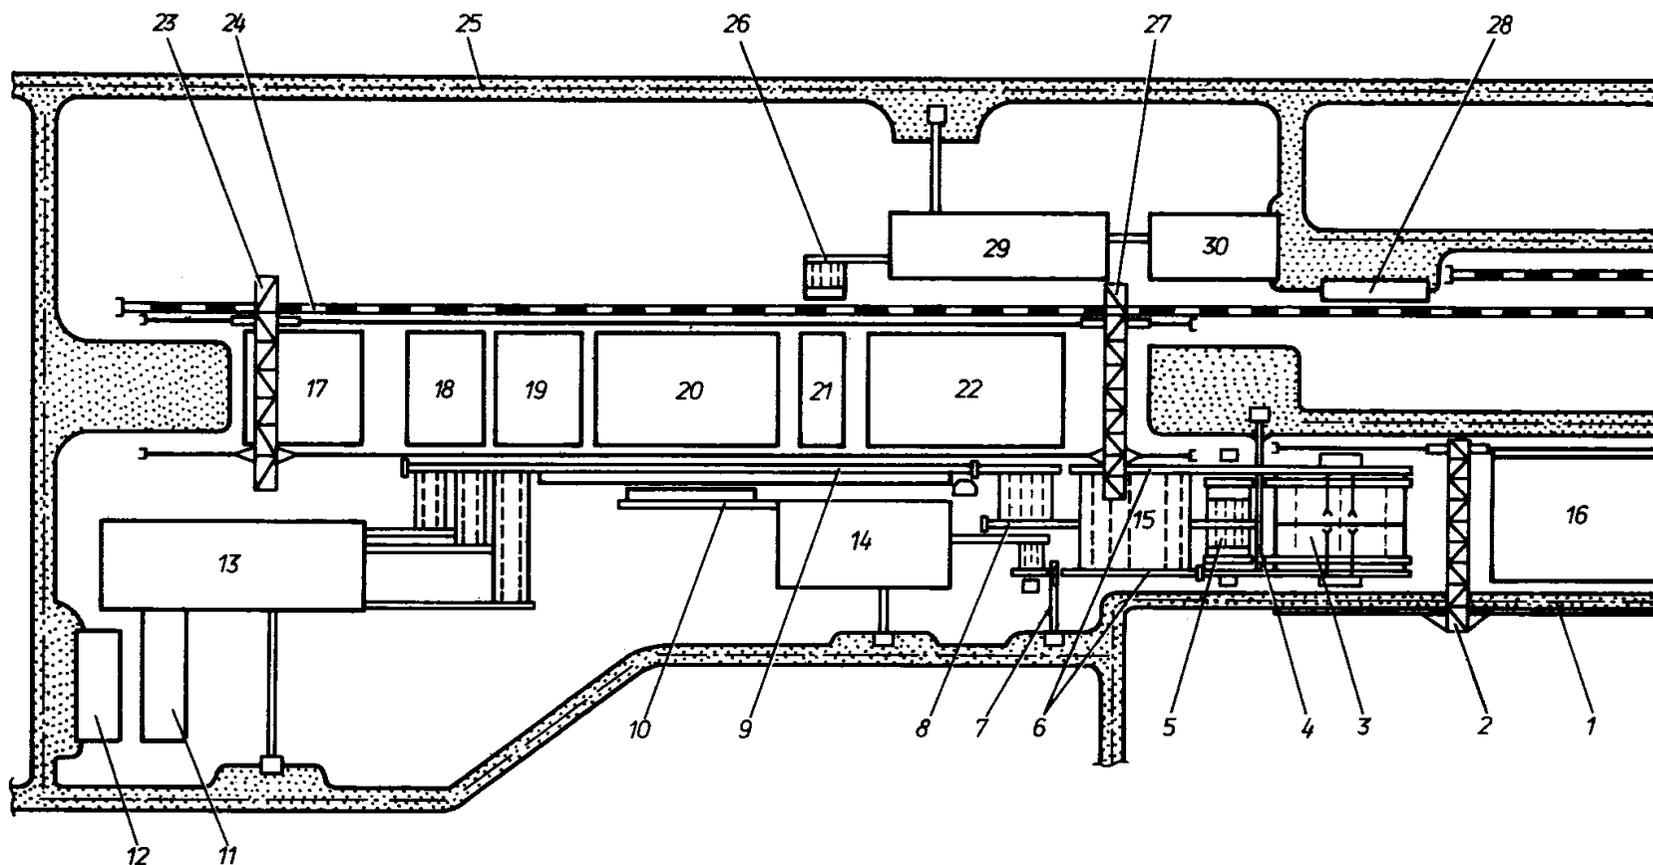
Лесной склад с переработкой тонкомерных хлыстов на специализированной линии: 1, 25 – автодорога; 2 – кран козловой; 3 – приемные площадки; 4 – раскряжевочная установка; 5 – разобшитель бревен; 6, 8 – выносные лесотранспортеры; 7 – разделочная установка; 9 – сортировочный лесотранспортер; 10 – лесотранспортер для выноса готовой продукции; 11 – площадка сортировочная; 12 – склад пакетов пиломатериалов; 13 – лесопильный цех; 14 – дровобалансовый цех; 15 – поперечный лесотранспортер; 16 – запас хлыстов; 17, 18, 19, 20, 21, 22, – штабеля круглых лесоматериалов; 23, 27 – консольно-козловые краны; 24 – железнодорожный путь; 26 – бункерный питатель; 28 – площадка для погрузки готовой продукции в вагоны; 29 – стружечный цех; 30 – склад стружки
